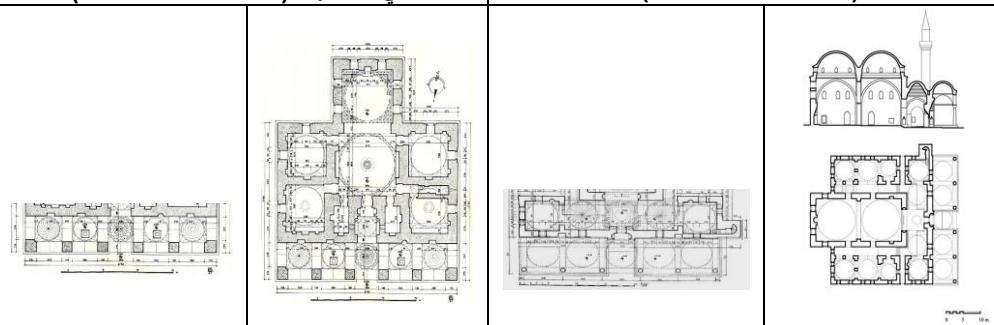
مسقّط أفقى لجامع ومدرسة مراد الأول في بورصة يوضح السقيفه التي تتقدم مخططهما.
